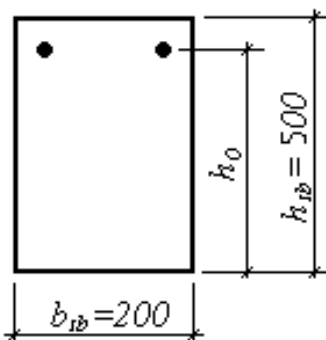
Розрахунковий переріз другорядної балки на опорах
